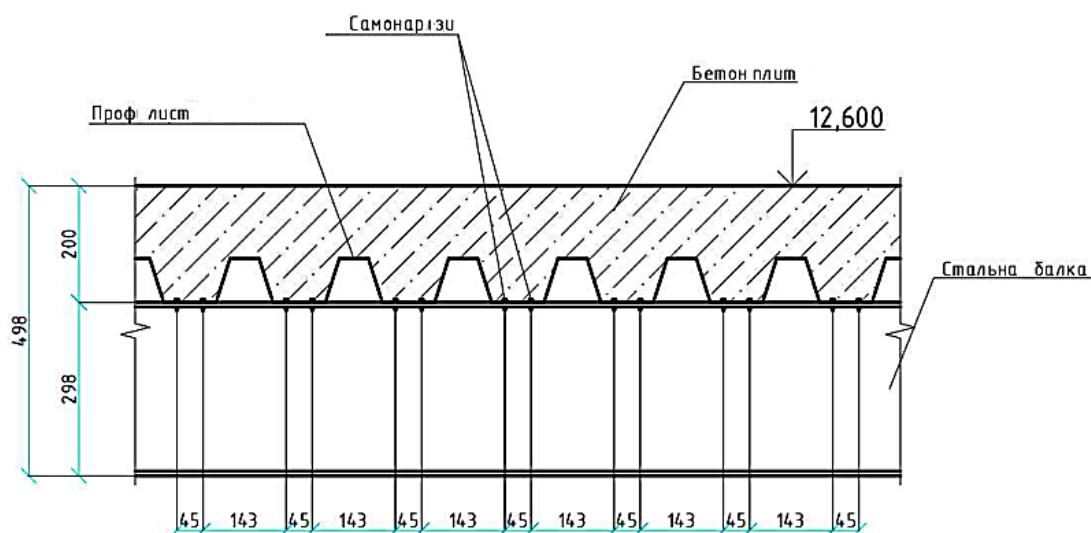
Конструкція сталезалізобетонного перекриття
